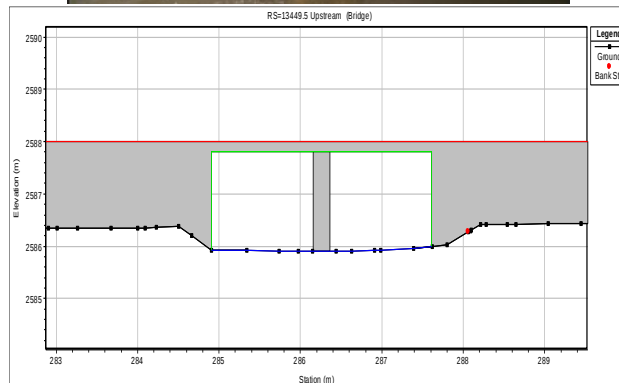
Geometría Box Culvert 2 implementado sobre el modelo.
